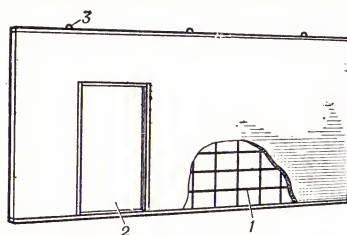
Перегородочная панель из гипсобетона: 1 — каркас; 2 — дверной проём; 3 — монтажная петля.
